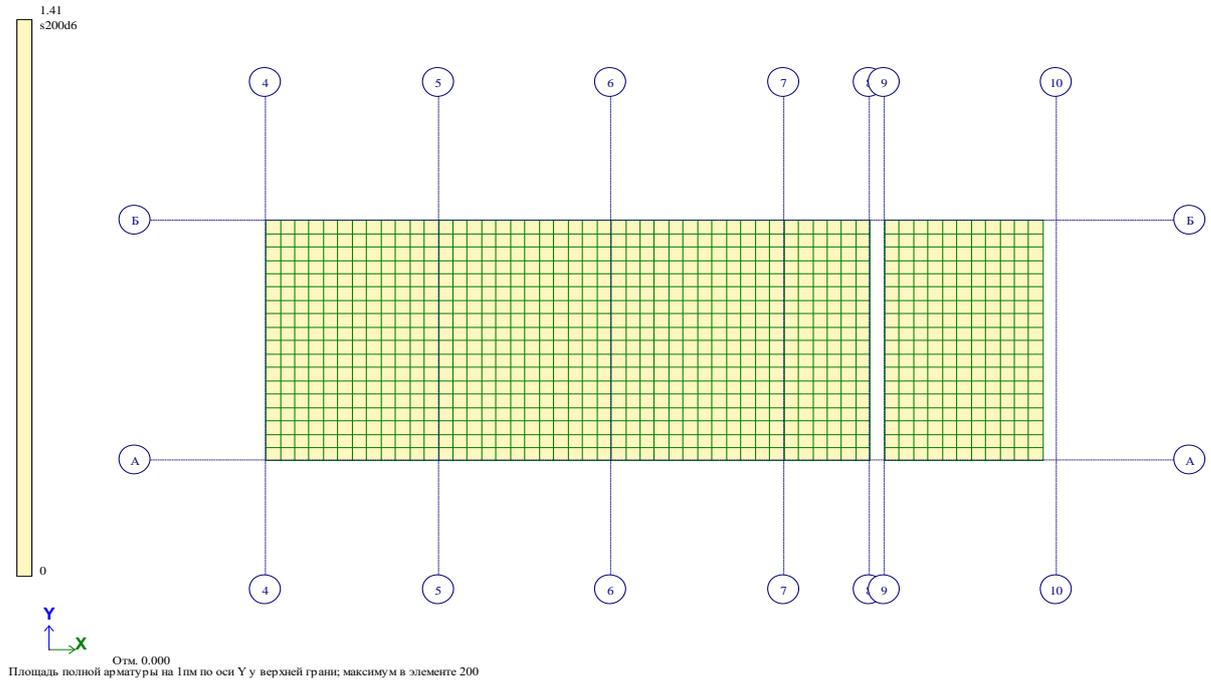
Требуемая площадь верхнего армирования по оси Y
